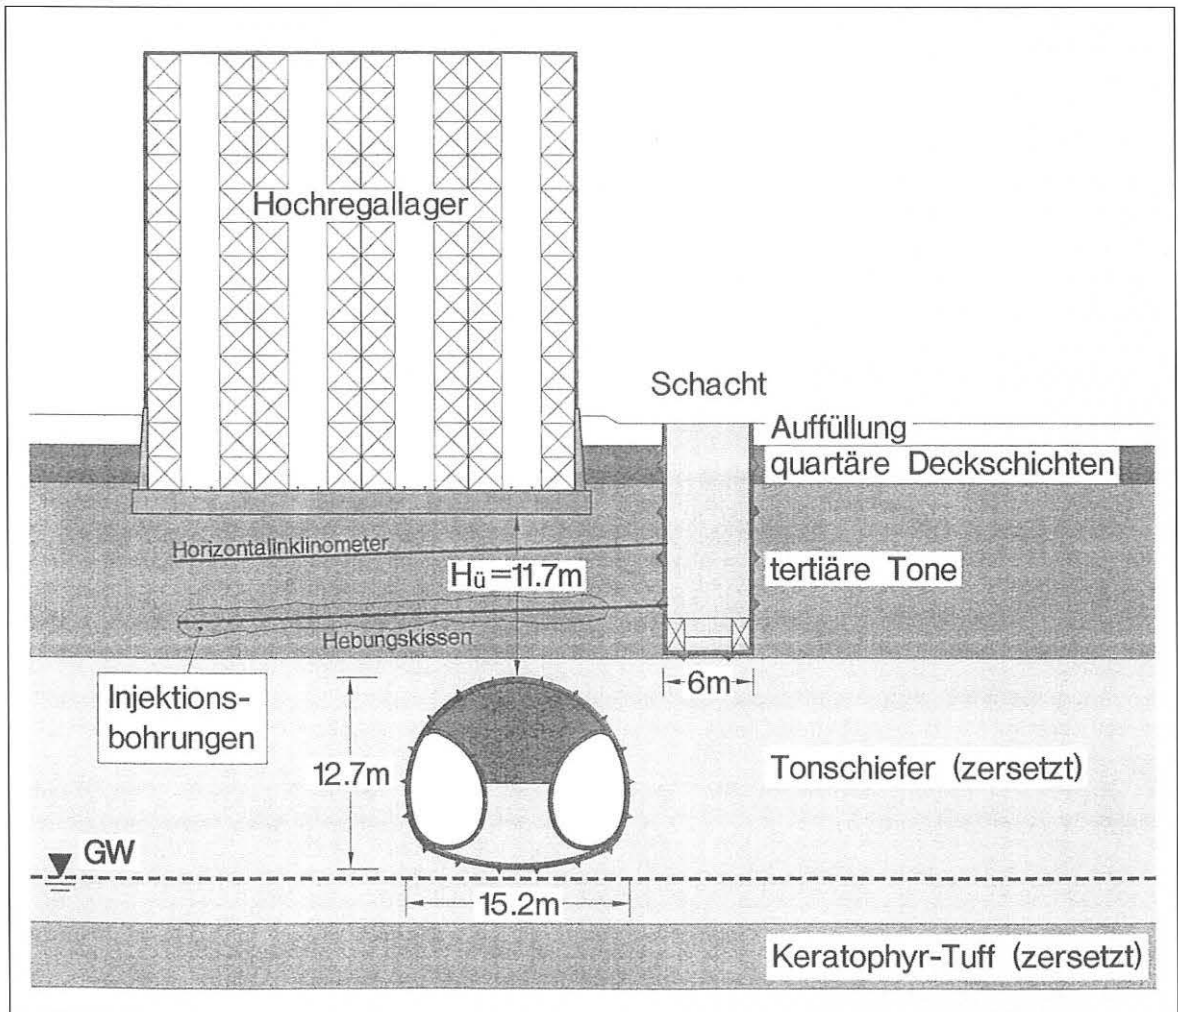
Tunnel Limburg, Unterfahrung Hochlager, Querschnitt
